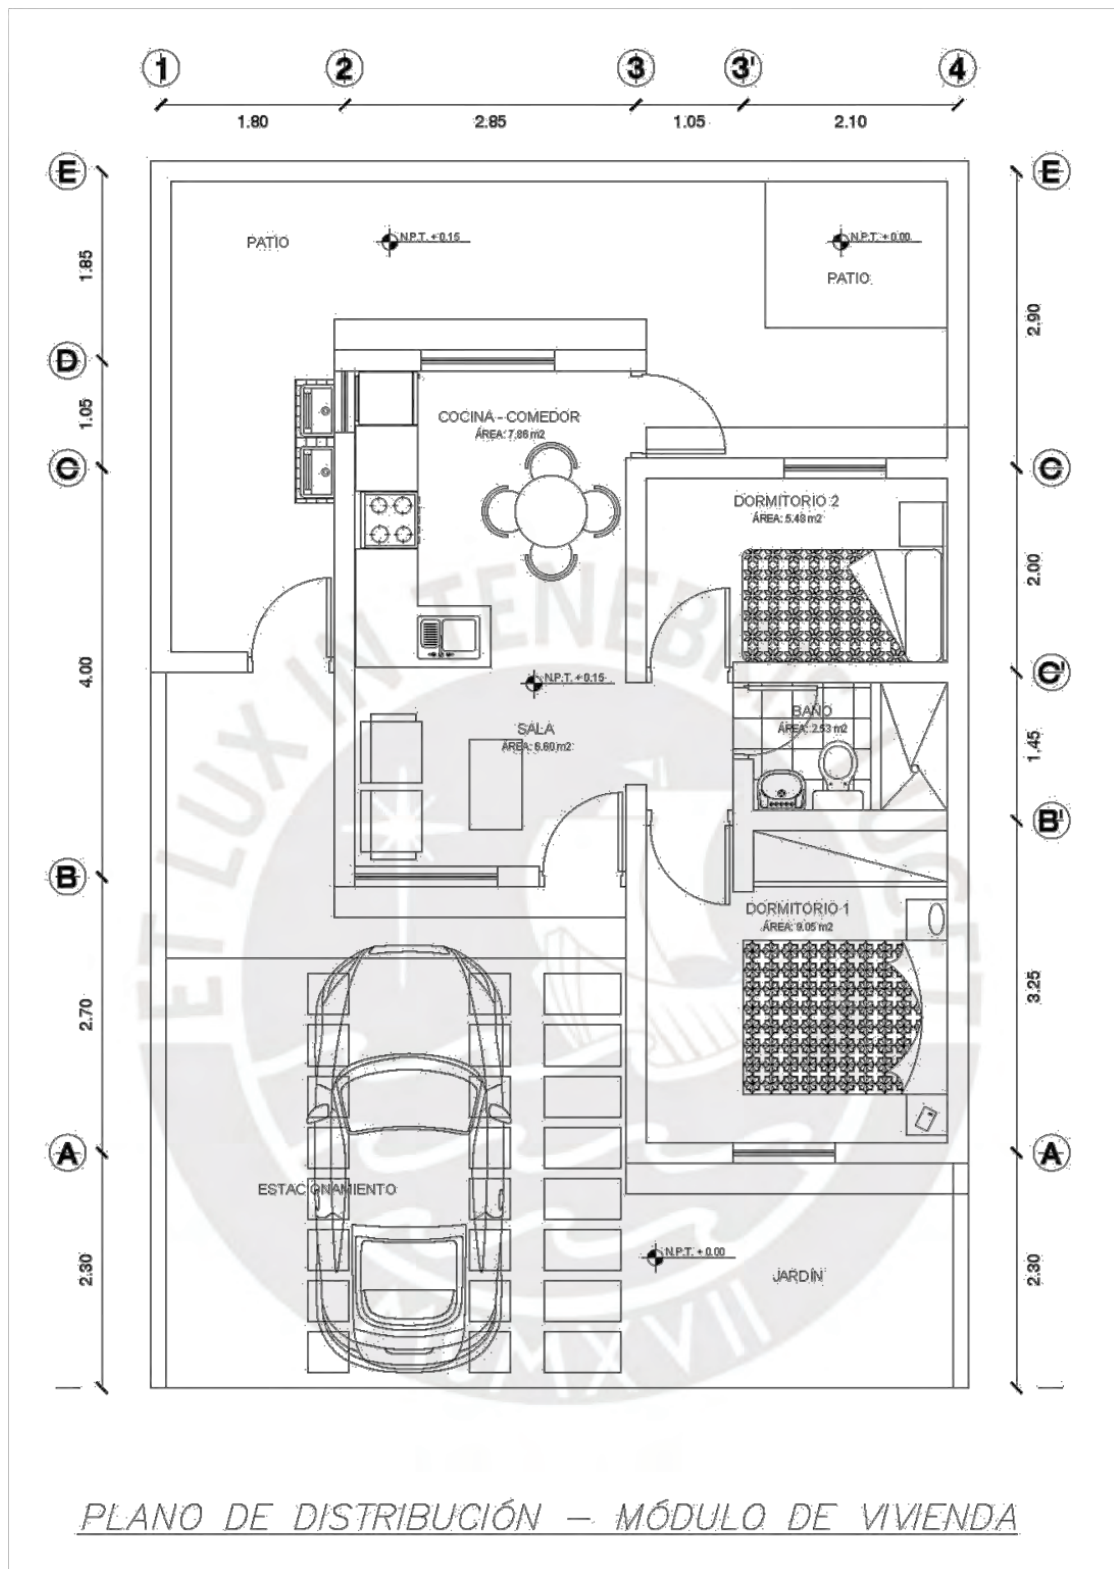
Plano de distribución en planta de la vivienda de albañilería confinada.
